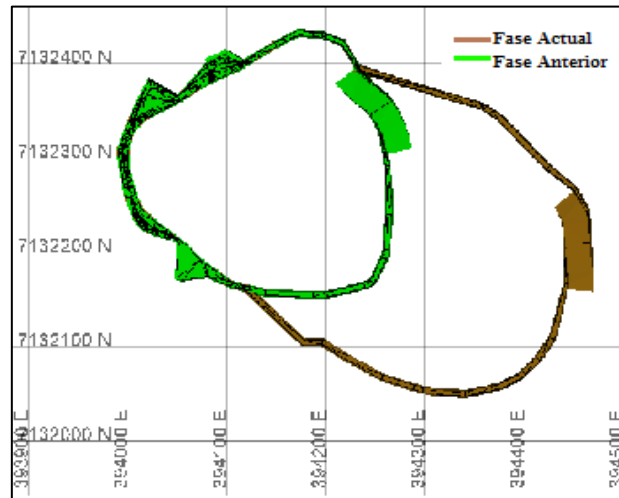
LG1Y Fase 4 - Vista en sección - Planta banco L1080
